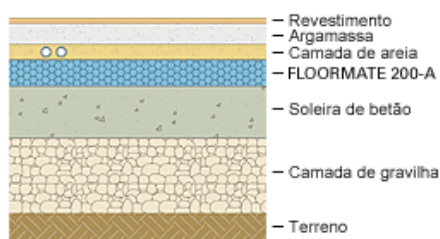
Isolante aplicado sobre o terreno [30]
